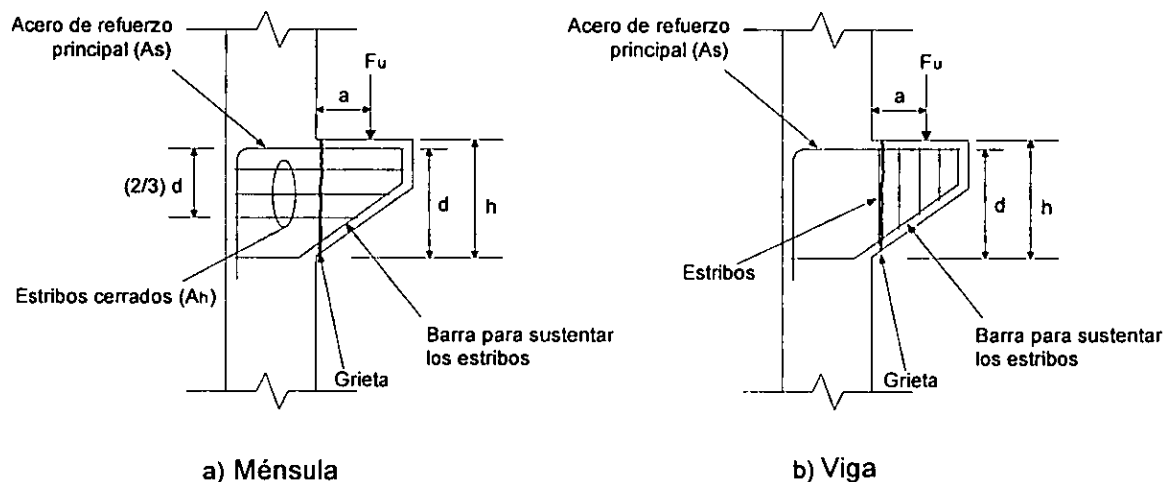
Distribución del acero de refuerzo en ménsulas y vigas
